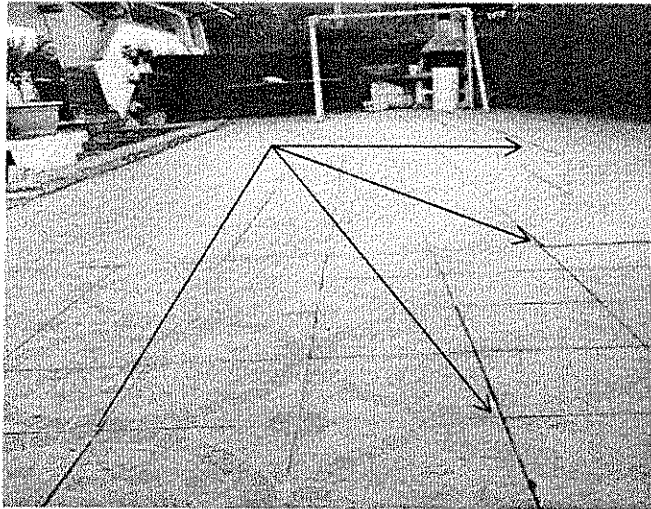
e 16 -Particolare inizio degrado di una parte Pavimentata della Corte/Giardino.
